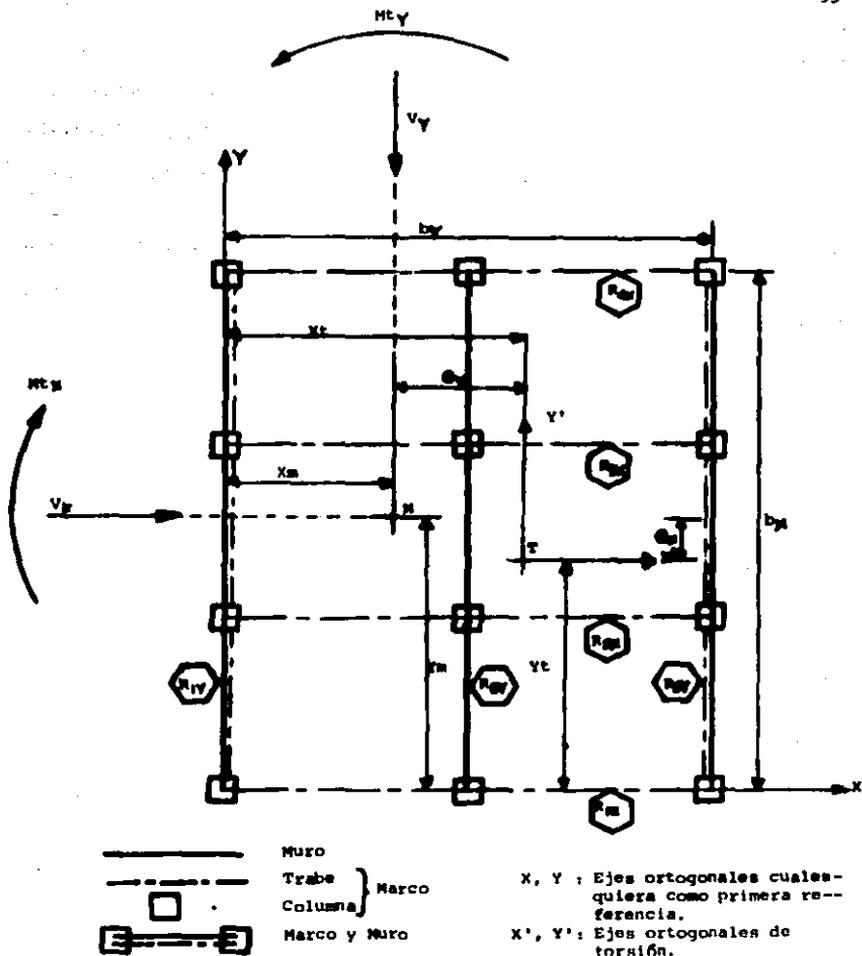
Planta de un entrepiso y los elementos que intervienen al considerar el efecto de torsión.
